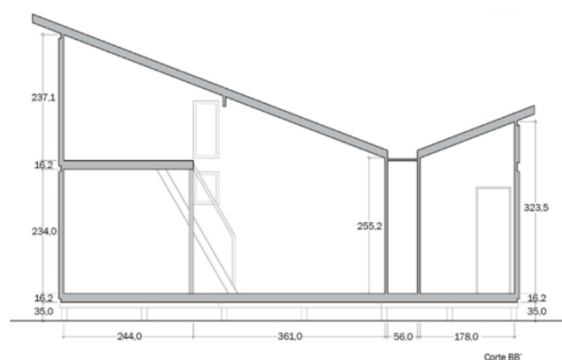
Corte BB'. Fuente: Gubins, J y Baixa, J. (2013).
